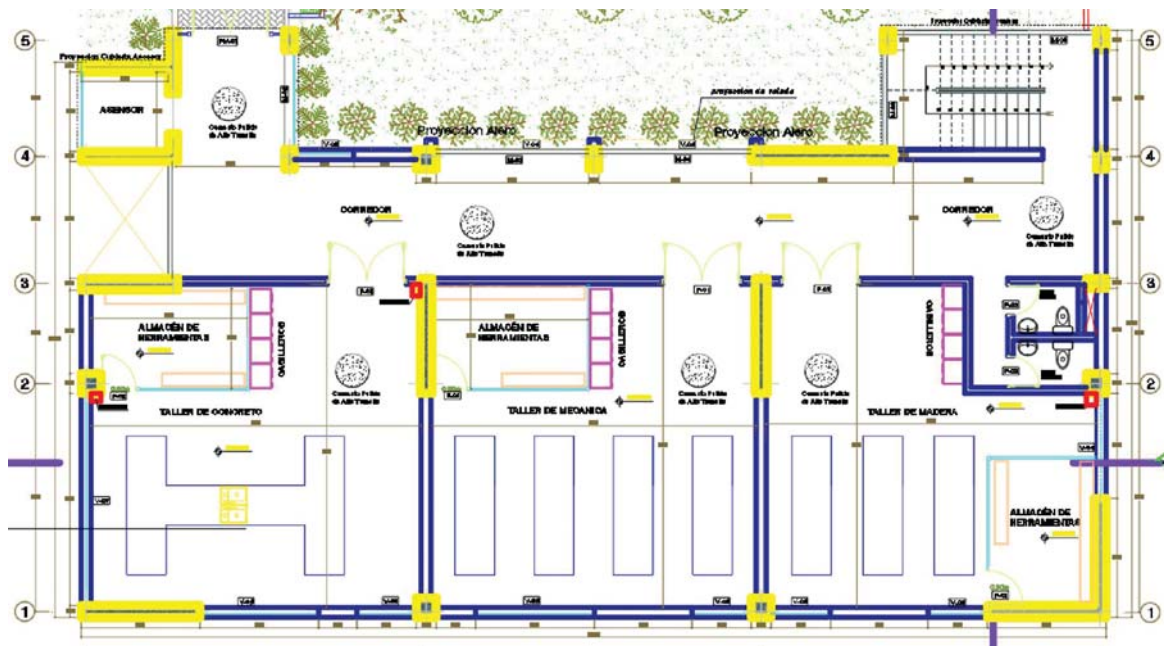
PLANTA DE DISTRIBUCION 1ER NIVEL
